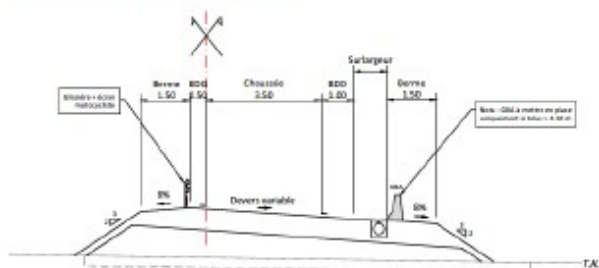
Profil en travers type - bretelle unidirectionnelle
